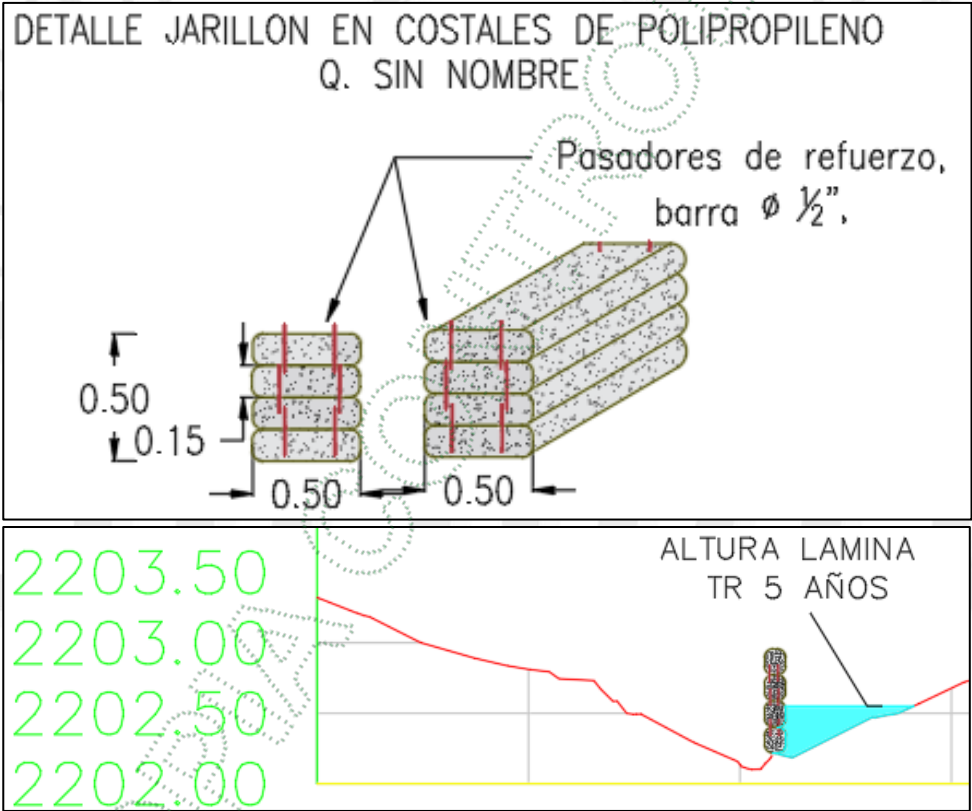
Tipo de la Obra:		Jarillón longitudinal
